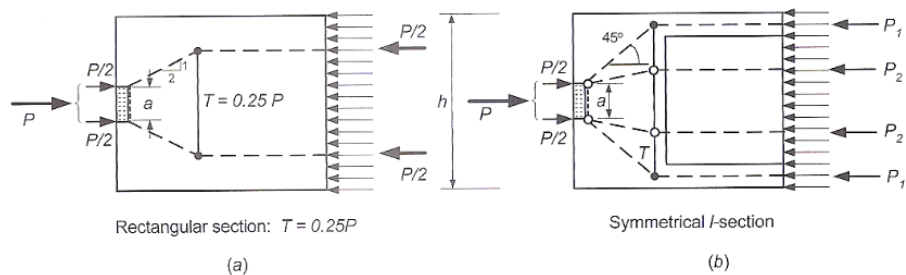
Modelo de escoras e tirantes para zonas de ancoragem de cabos de pré-esforço com aplicação de pré-esforço centrado, em a) para vigas com secção retangular e b) para vigas com secção transversal simétrica em forma de I [19].
